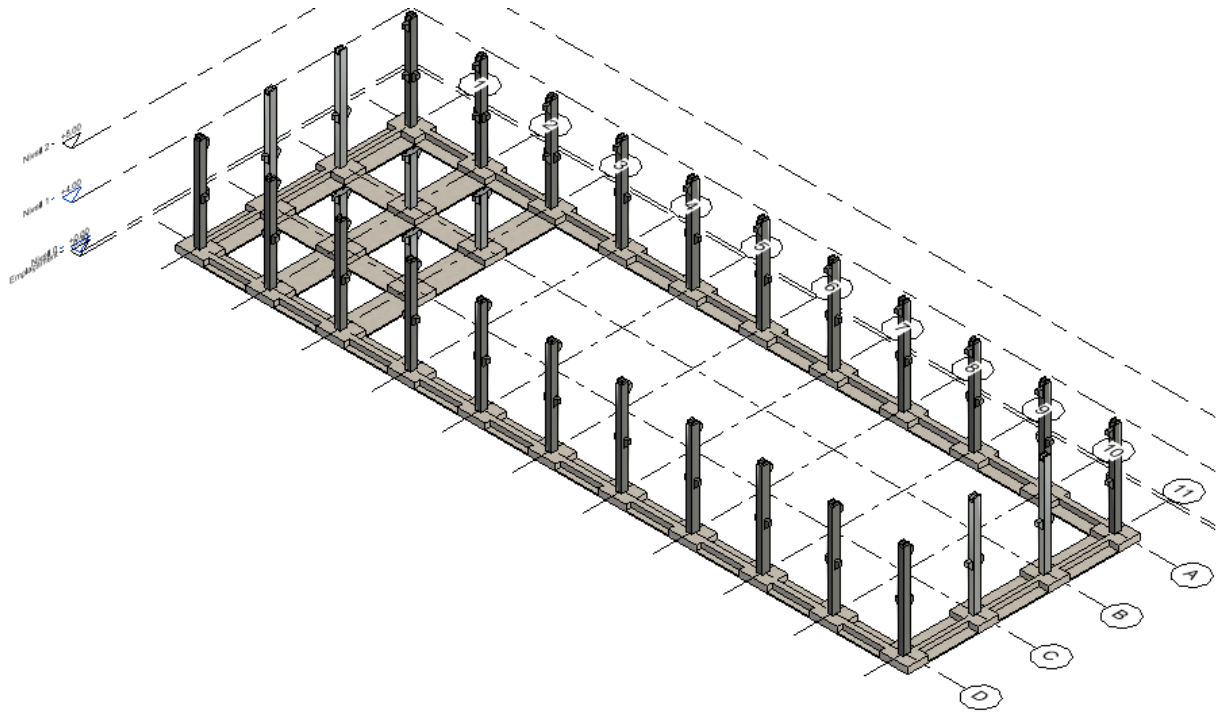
Col·locació dels pilars prefabricats. (Font: "Revit")
